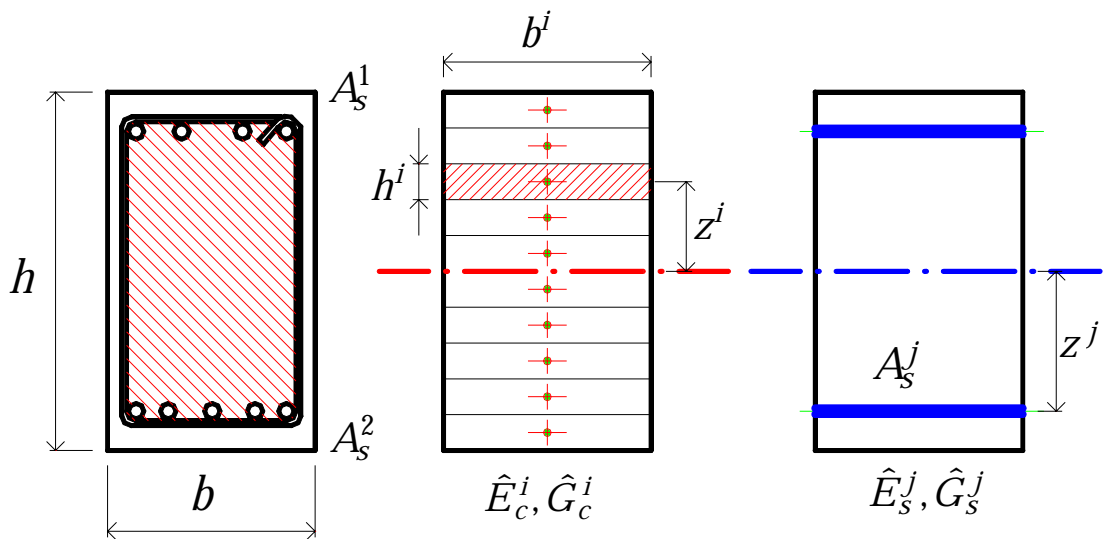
Discretización de una sección de hormigón armado mediante fibras. a) Núcleo de la sección confinada por estribos; b) Fibras correspondientes al hormigón confinado; c) fibras correspondientes al acero
